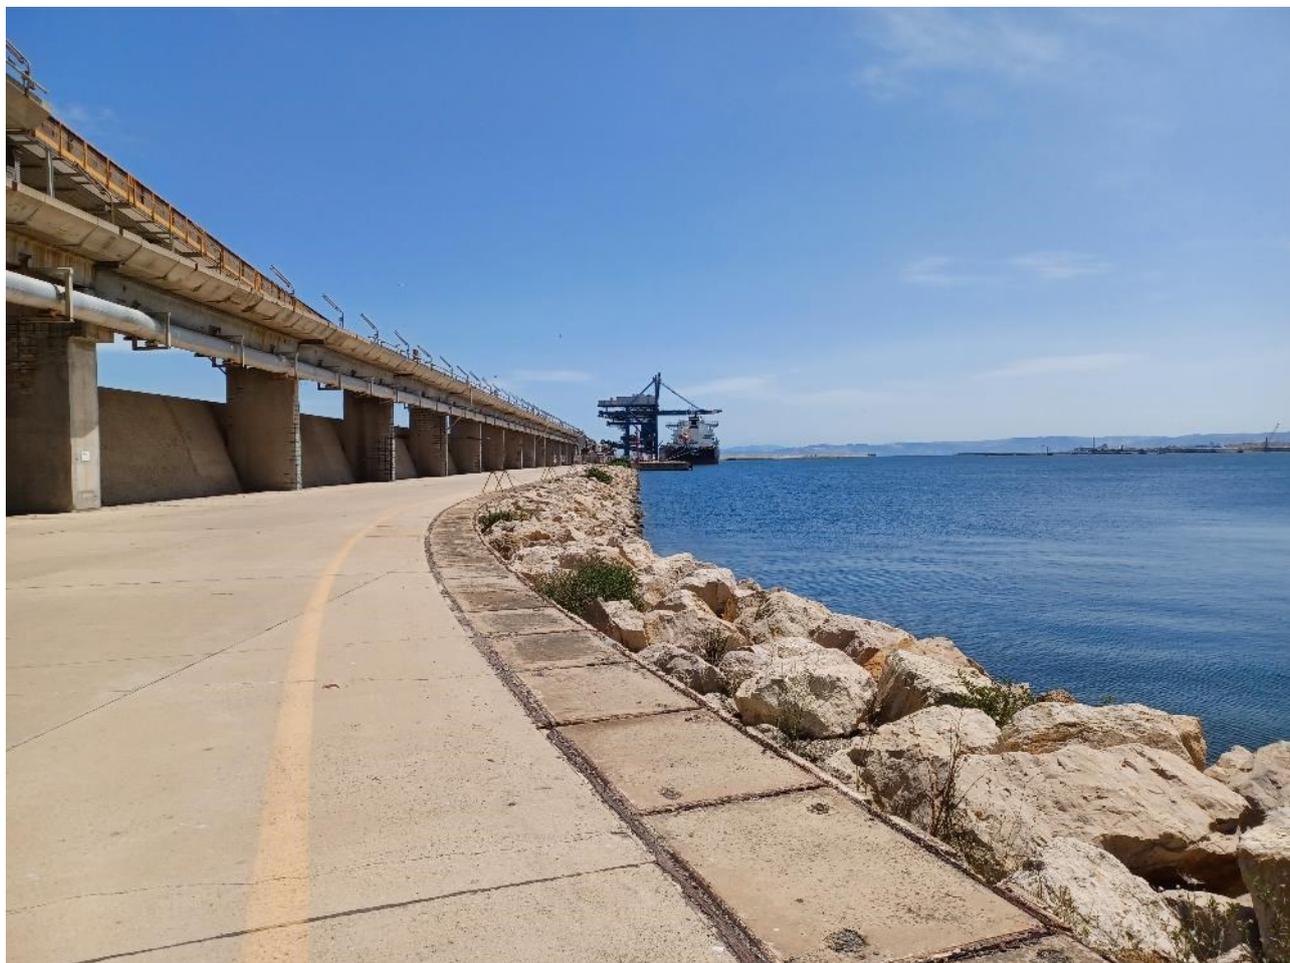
Foto No. 11 – Vista da Ovest sull’Area di Intervento in Banchina
